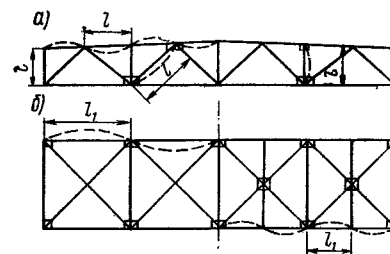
К определению расчетных длин (а, б) элементов верхнего пояса ферм
